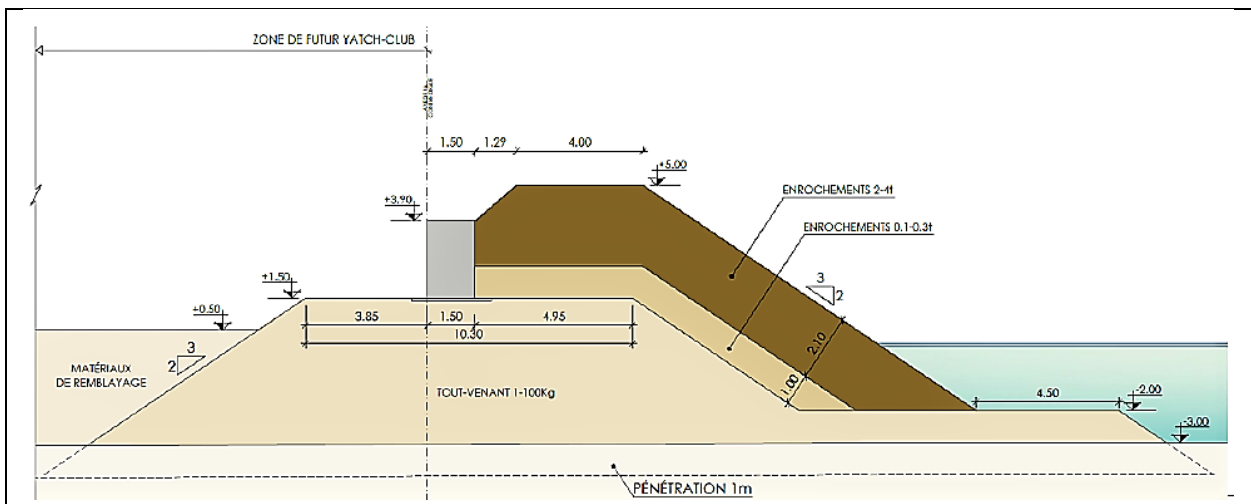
Coupe type de la section courante de la jetée secondaire. (BTP Infrastructuras)
